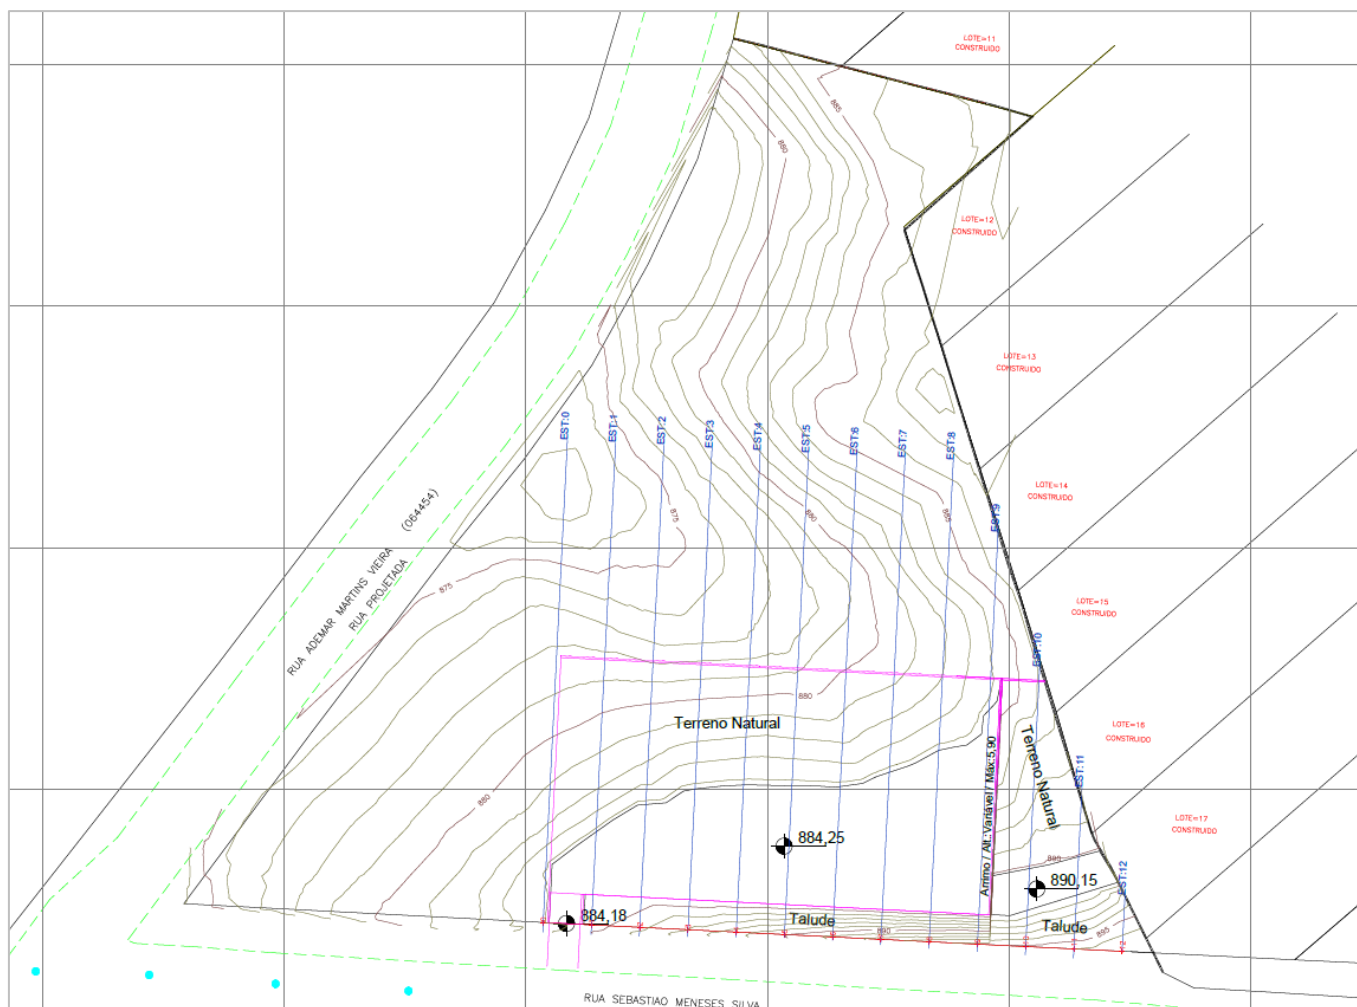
Planta do projeto de terraplenagem (Fonte: arquivo “Azimute_ - _Projeto_T.pdf”).
